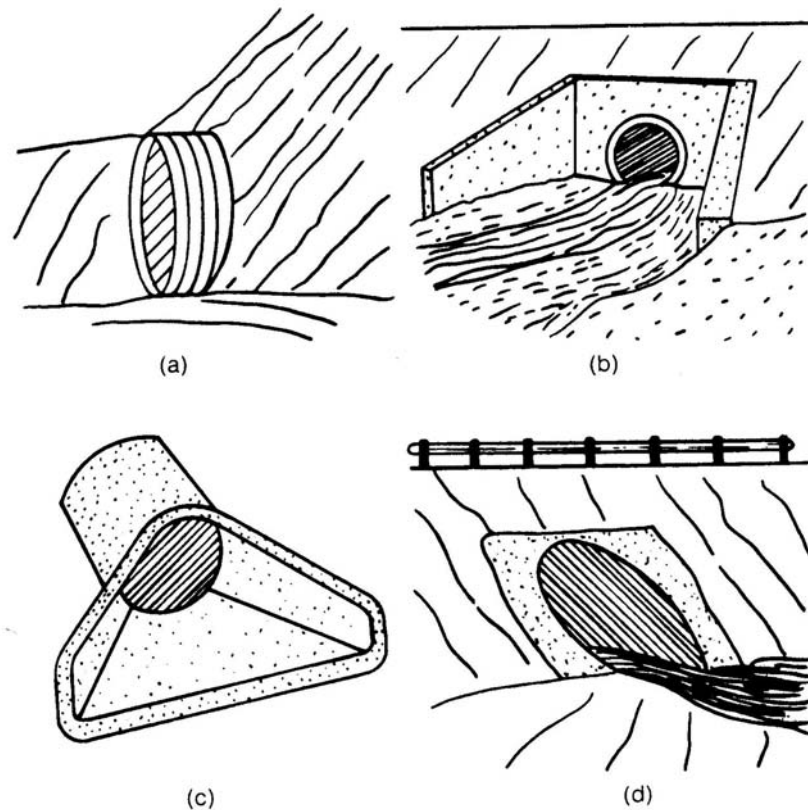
Secciones transversales de alcantarillas (Fuente: Manual of Practice N° 77, ASCE, 1992).
